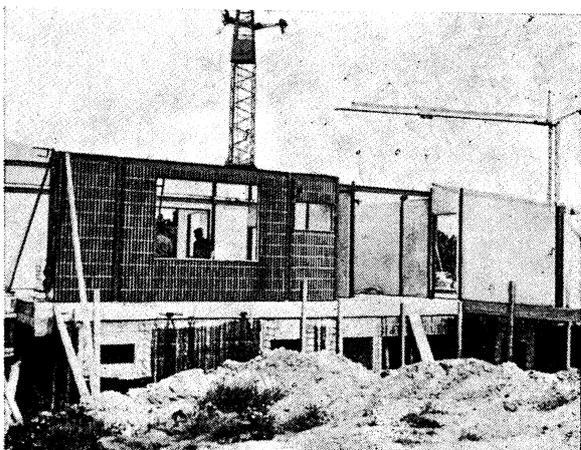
Construcción de una casa con elementos nulares prefabricados con hormigón ligero de Styropor: Los ladrillos se han situado en los moldes, en el momento de fabricar los elementos.
